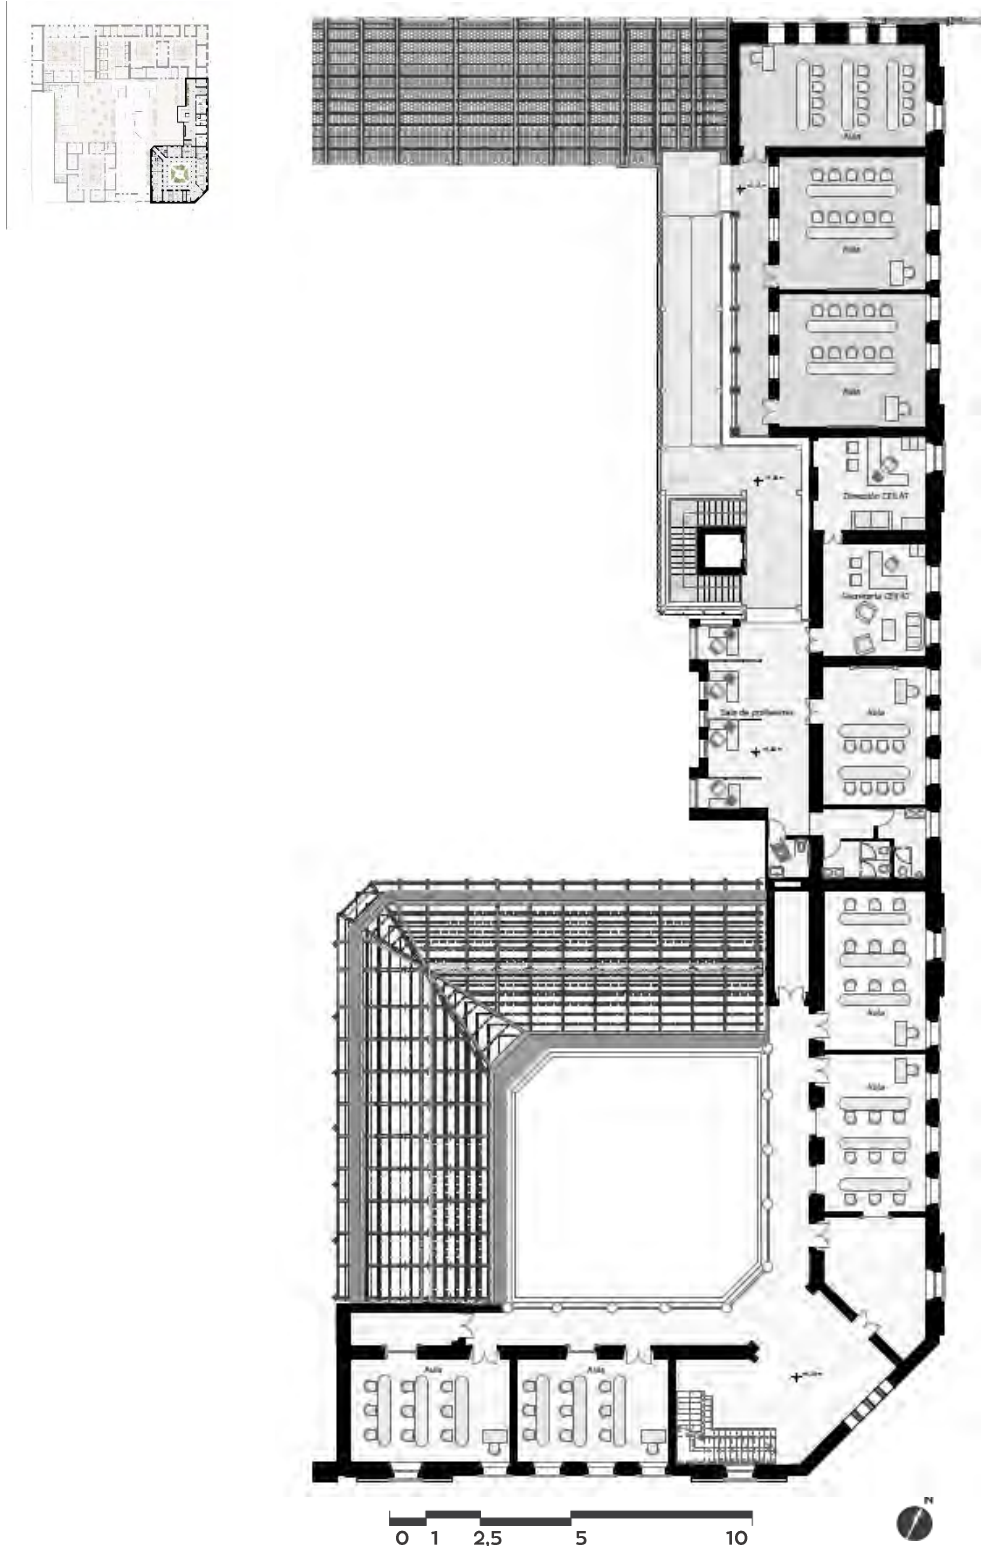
Planta Tercera ala oriental CEILAT. Fuente: Elaboración Propia.
